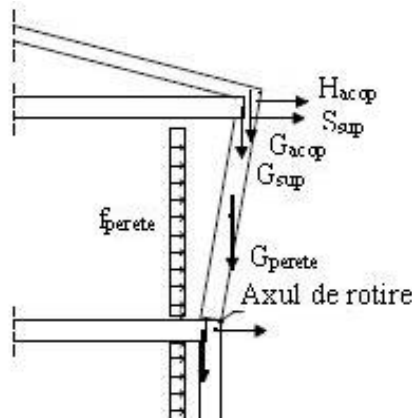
Mecanismul de răsturnare al unui perete pentru acțiunea seismică perpendiculară pe plan.
